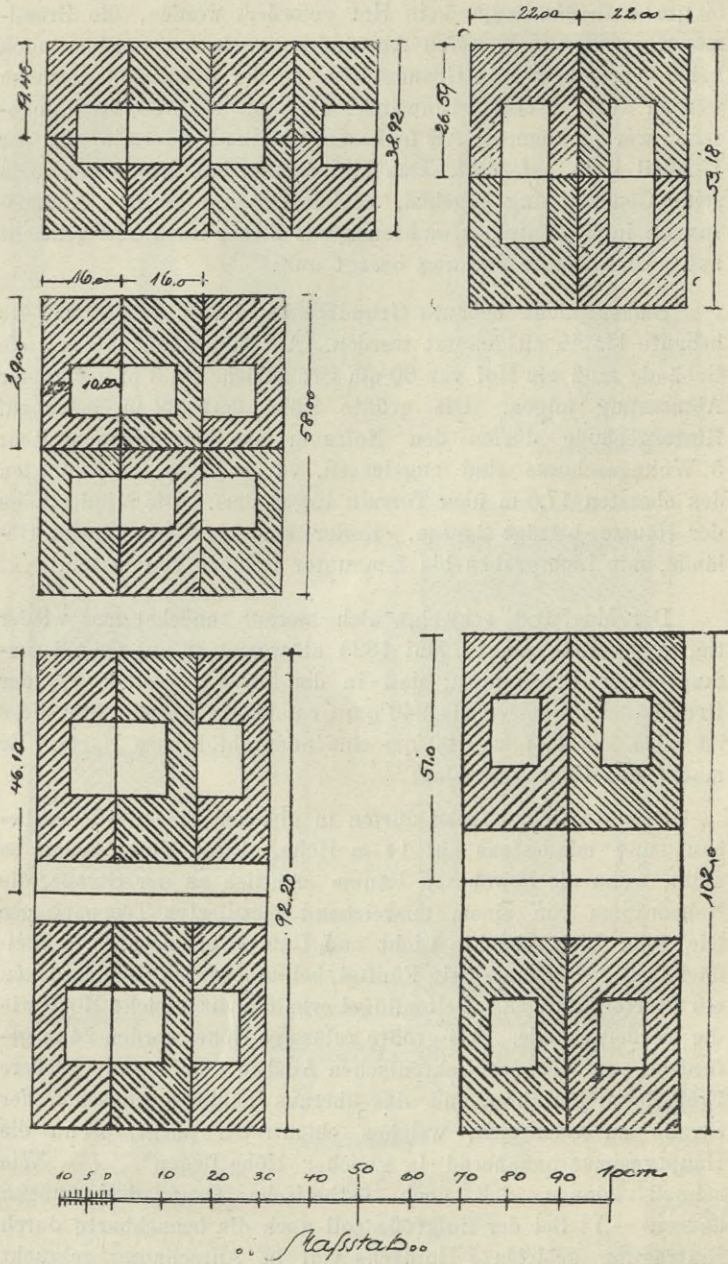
Grundstück- und Baublocktiefen bei voller Ausnutzung unter Zugrundelegung normaler Grundstückbreiten nach der B.P.O. vom 15. August 1897
